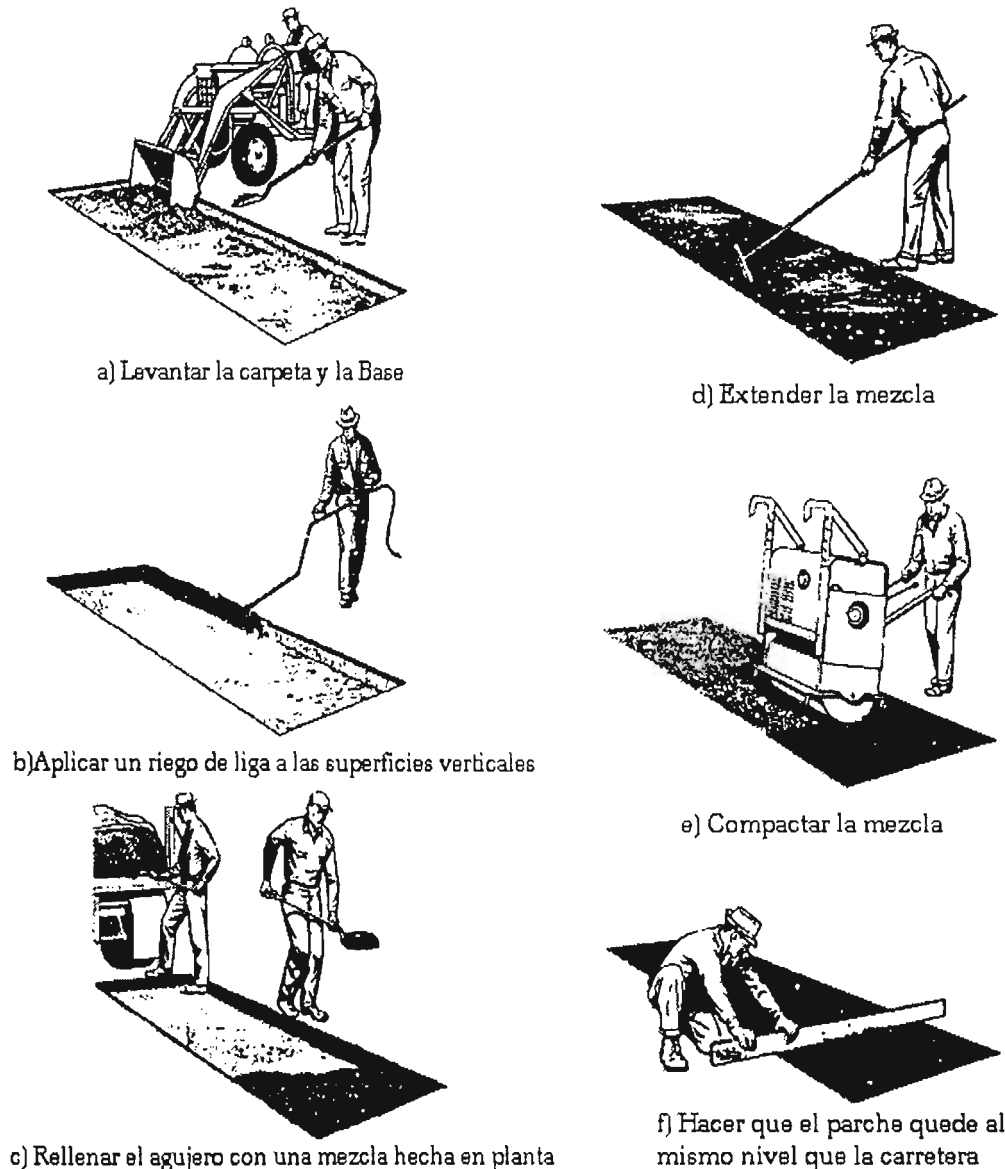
Bacheo superficial de un pavimento asfáltico. (The Asphalt Institute)
